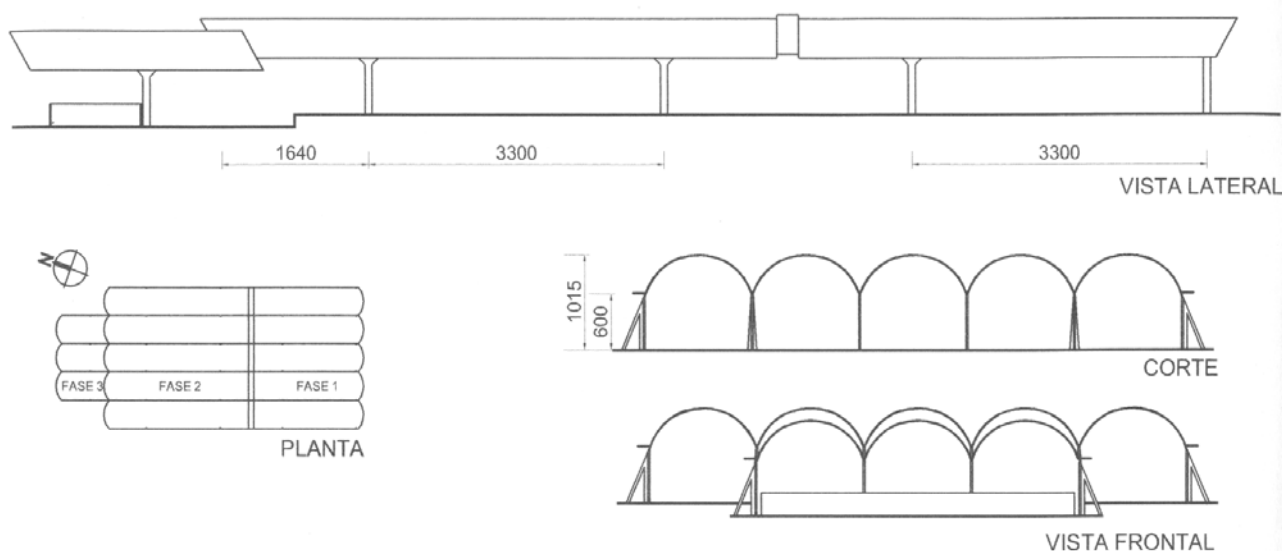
Croqui estrutural da Agroindústria Massaro: planta, corte e vistas.
